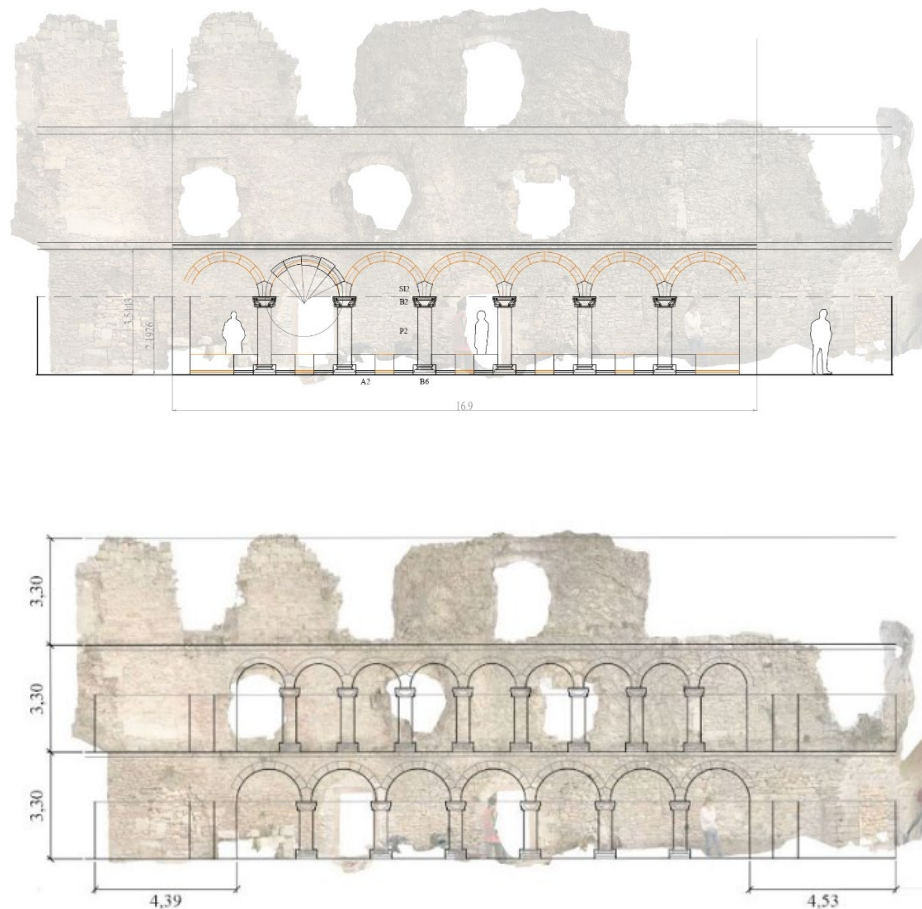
Posibles reconstrucciones (Fuente: MUCRPA)
